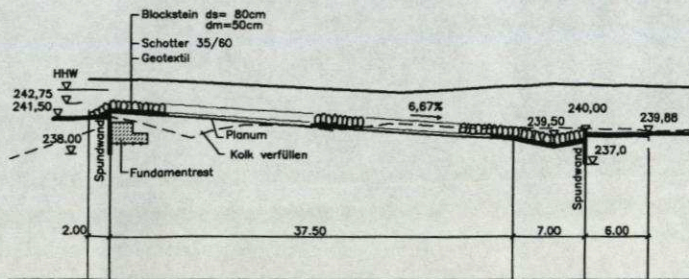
Längsschnitt der geplanten Blocksteinrampe
